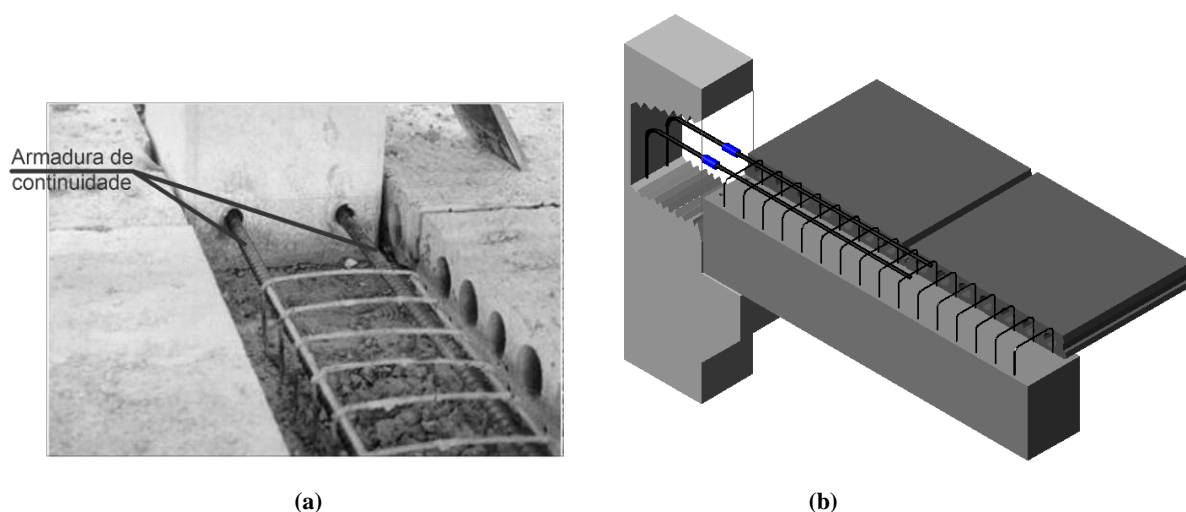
8 – Ligação semi-rígida: (a) Armadura de continuidade em um pavimento; (b) Esquema de ancoragem nos pilares de extremidade (FONTE: Ferreira, 2008).
